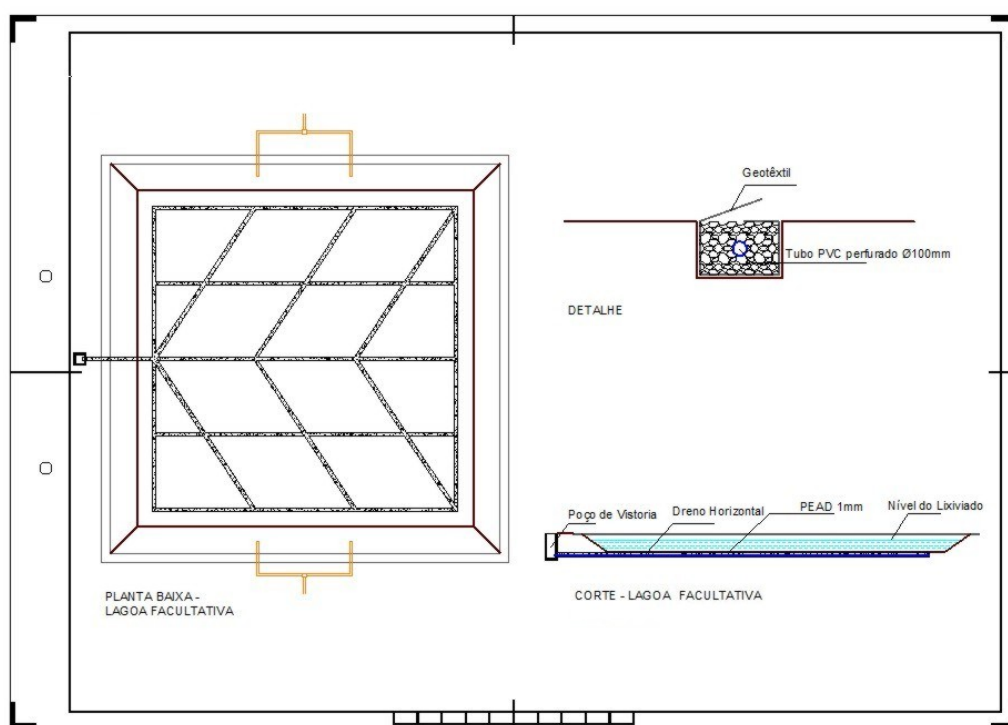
Layout, corte e detalhe do sistema de drenagem de biogás da base da lagoa facultativa.
